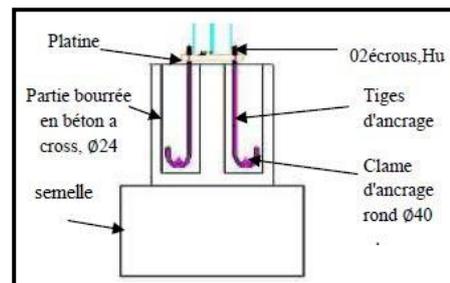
Détail n°01: Articulation pied de poteau- fondation
